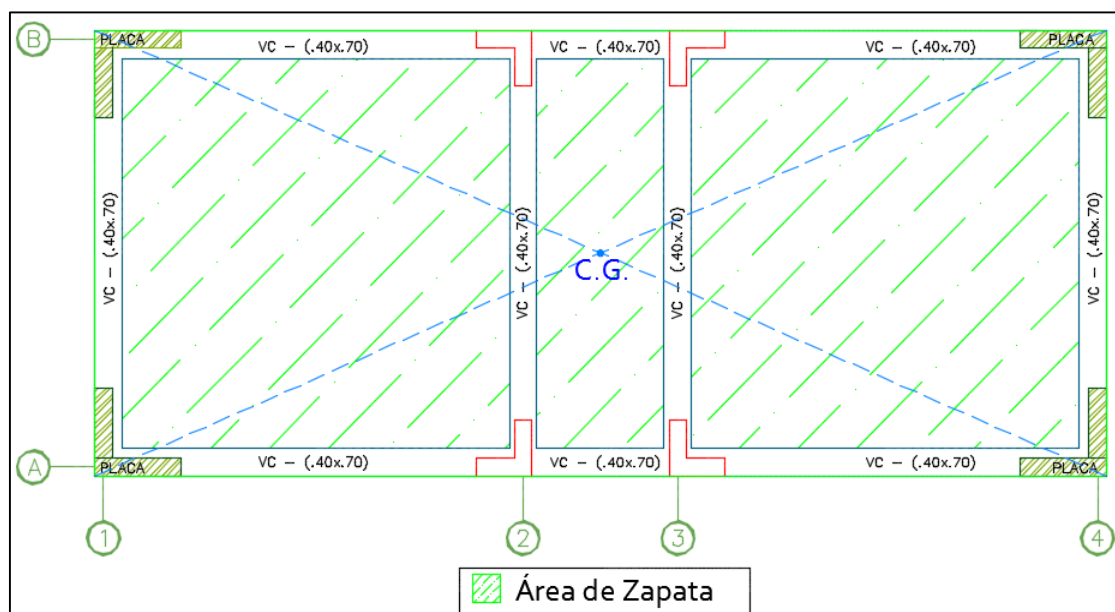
Área de contacto losa de cimentación - Sistema dual tipo I
